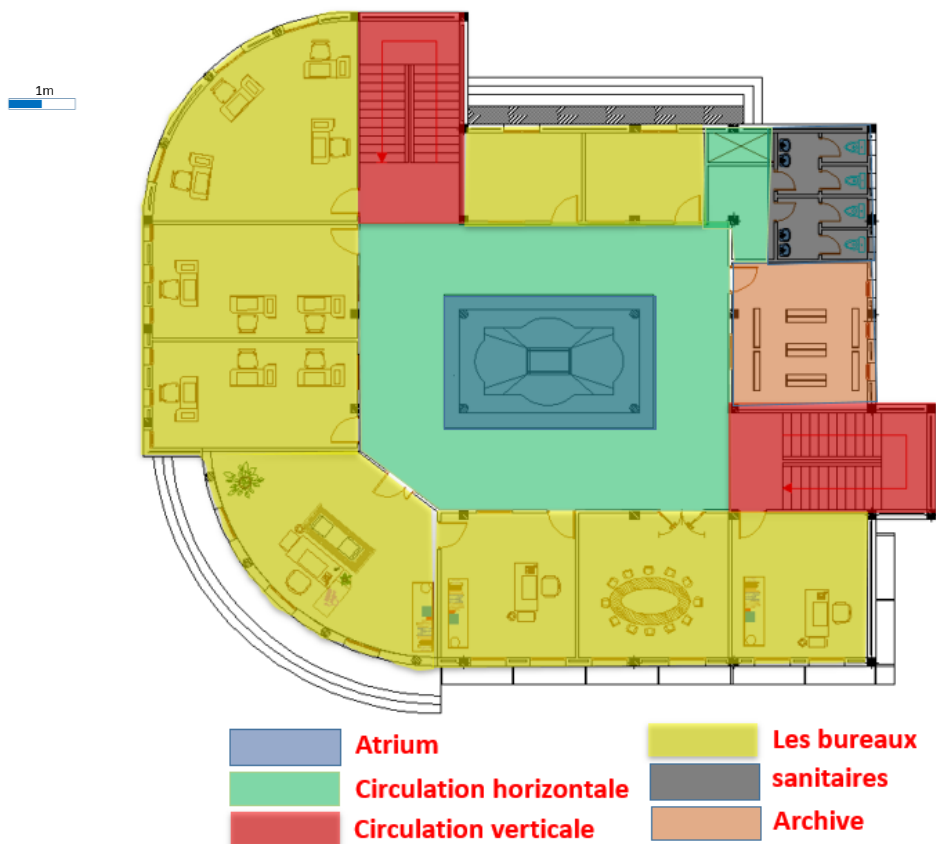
le plan de 2 Emme étages, AUTEURS
